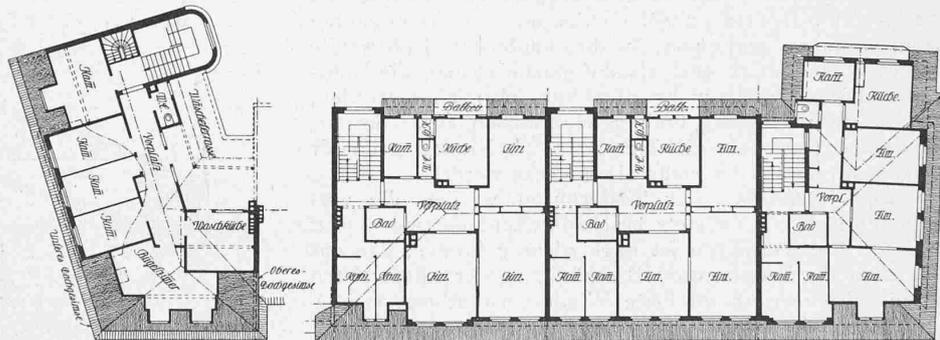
und 5. Grundrisse der Zwischengeschosse und des ersten, bzw. zweiten Dachgeschosses. — 1 : 400.
